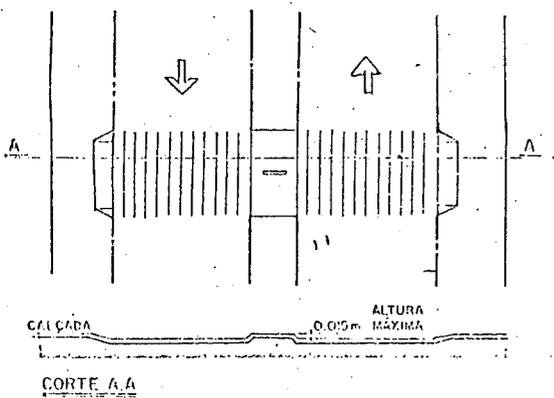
ESQUEMA DO CORTE DO CANTEIRO CENTRAL EM LOCAIS COM REBAIXAMENTO DE GUIA EM MEIO DE QUADRA (PROJETO-TIPO I)
